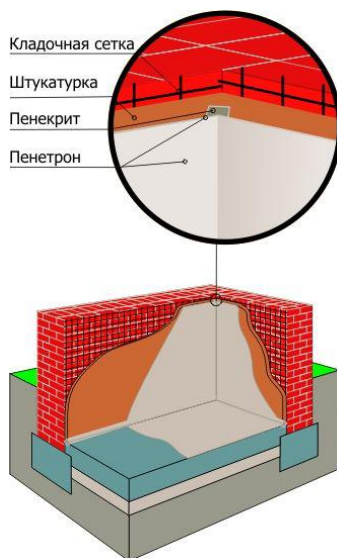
Гидроизоляция по кирпичной стене изнутри
